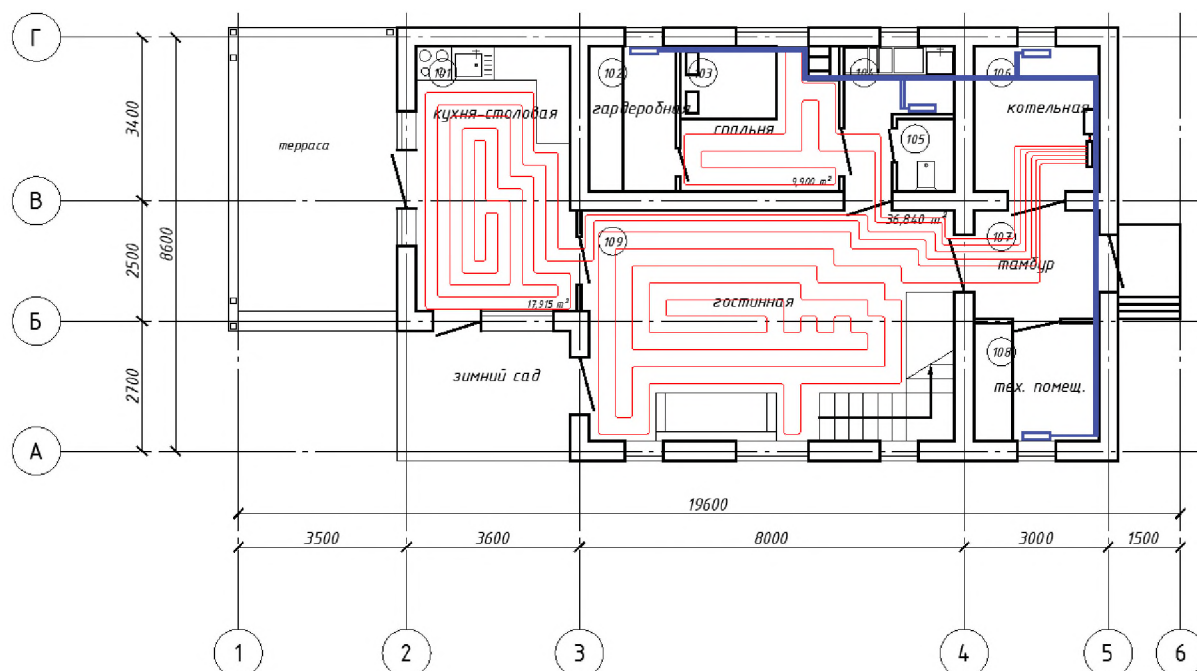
План первого этажа индивидуального жилого дома с нанесением элементов запроектированной системы водяного отопления
